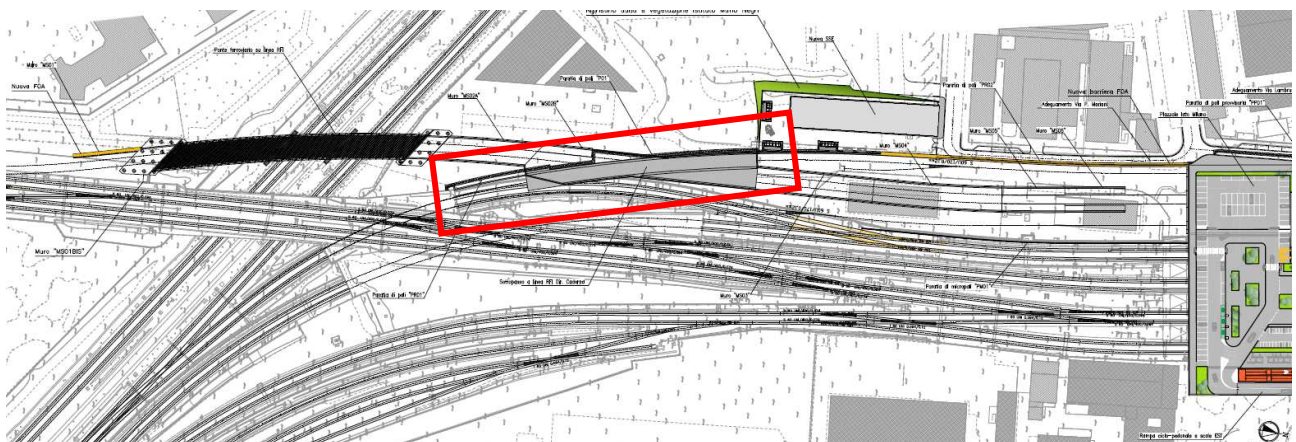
Planimetria generale opere con indicazione del manufatto scatolare.
